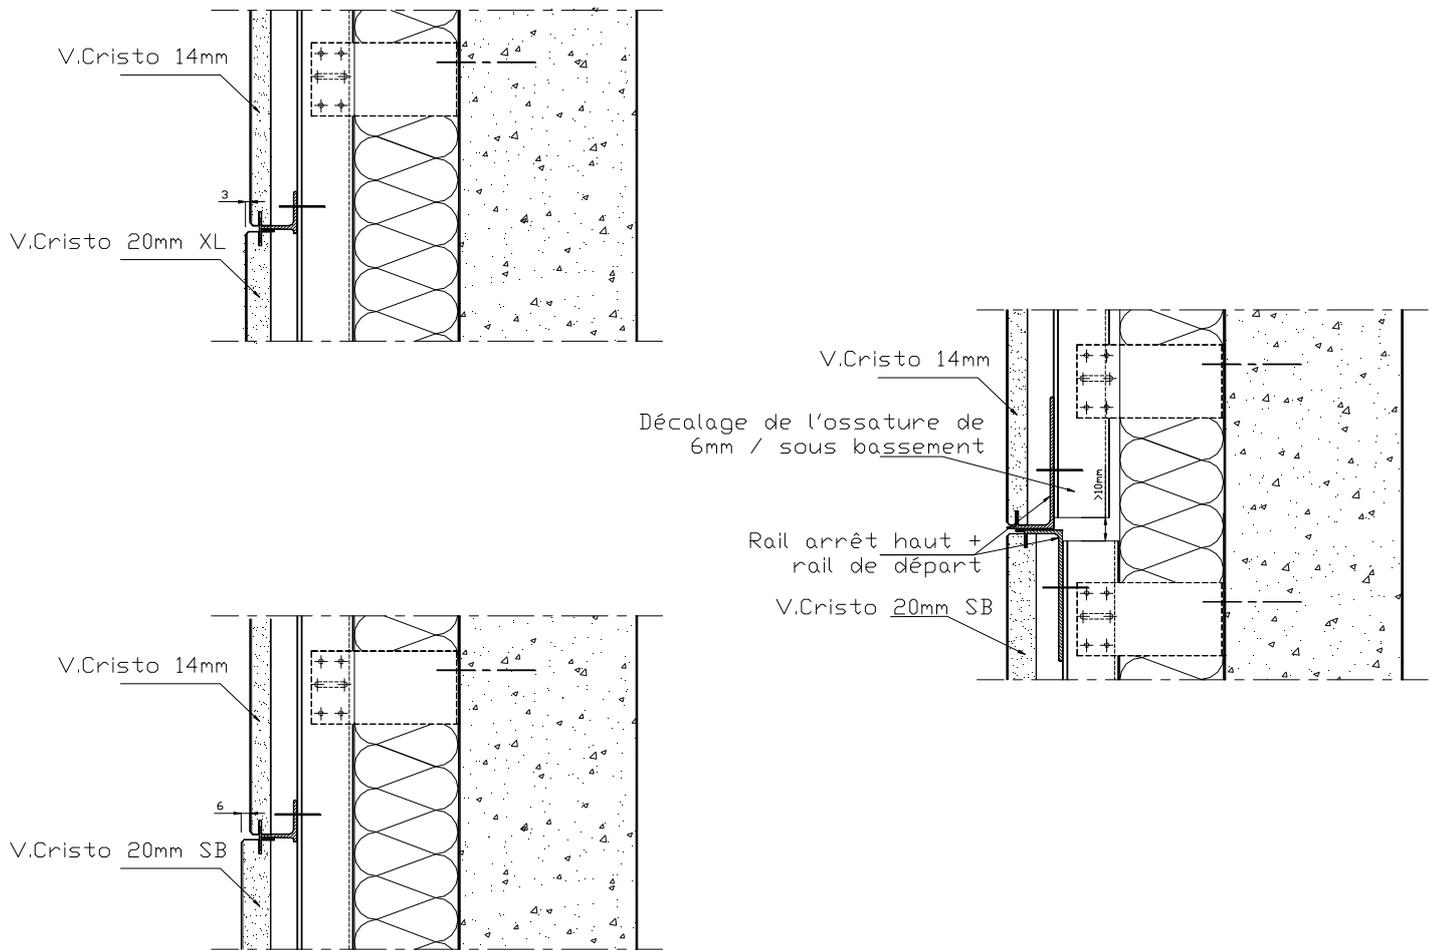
Principe d'alignement sousbassement/façade – Coupe verticale – joint horizontal
